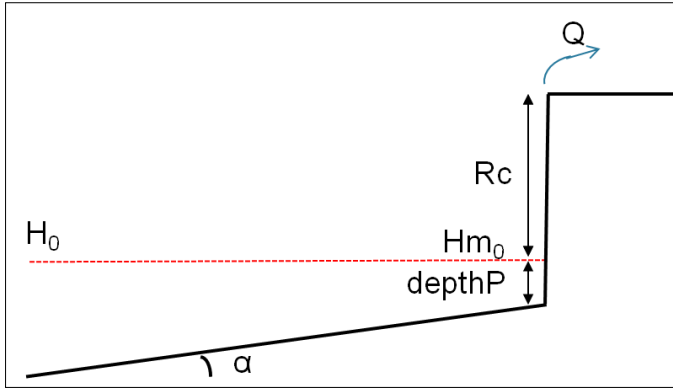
Procedura per il calcolo del *run-up* nel caso di parete sub-verticale o barriera di protezione aderente. Parametri: Q =portata di *overtopping*, R_c =altezza della porzione emersa della barriera e/o parete sub-verticale; $depthP$ =profondità al piede della struttura; H_{m0} =altezza d'onda al piede della struttura; H_0 =altezza d'onda significativa *off-shore*; α =angolo d'inclinazione del fondale al piede della barriera.
